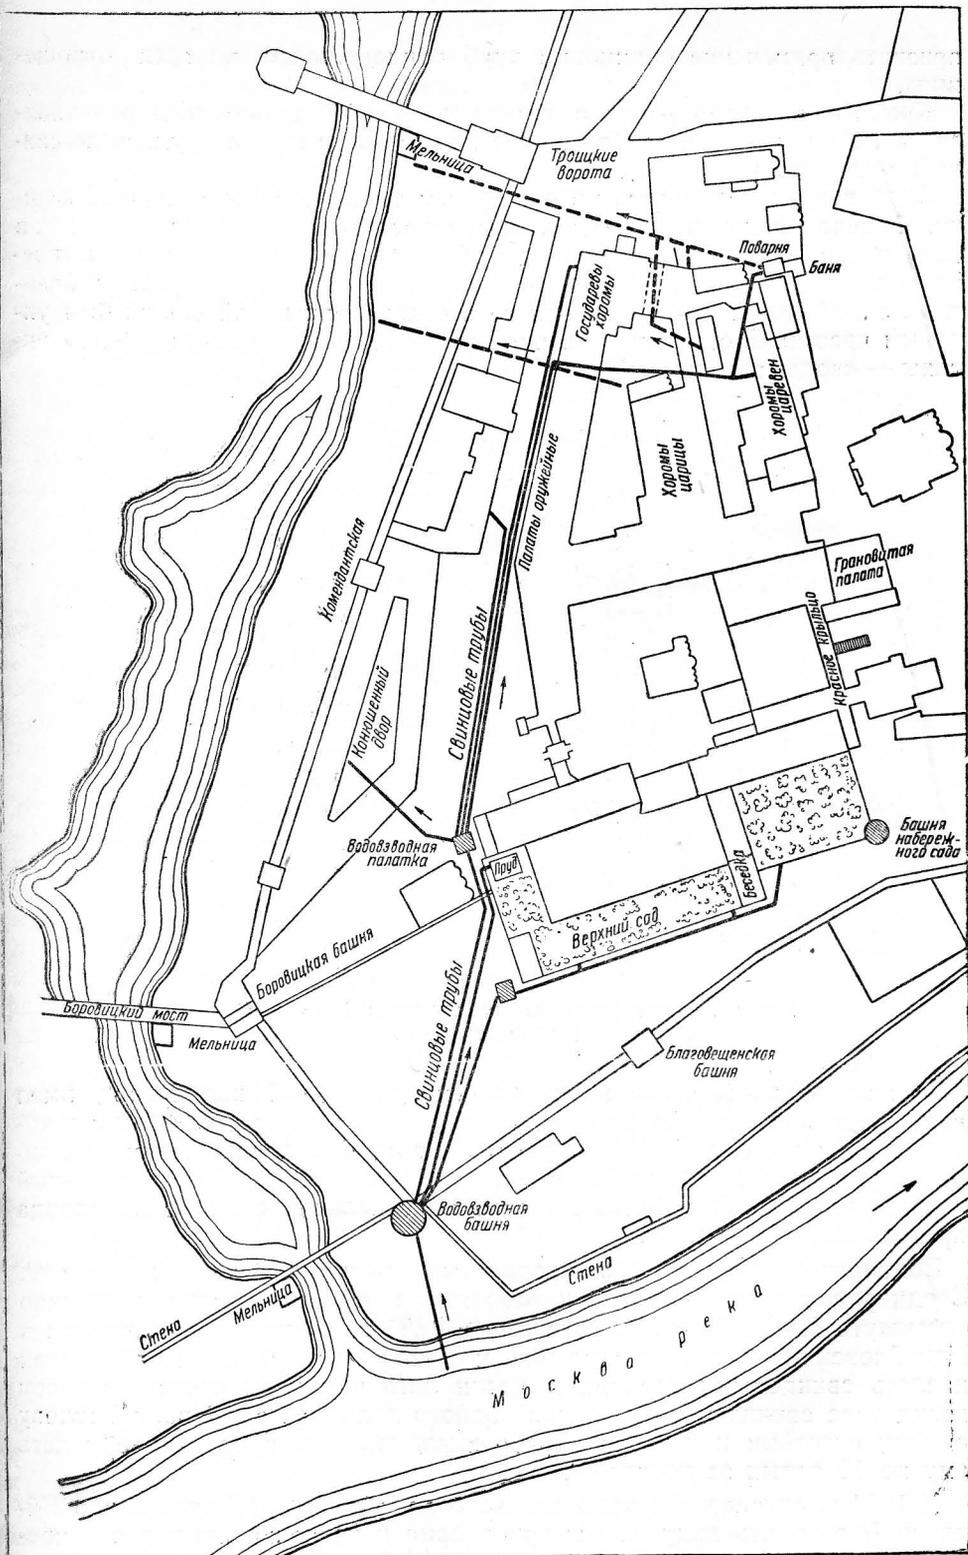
Схема водопровода и канализации в Кремле (реконструкция).
